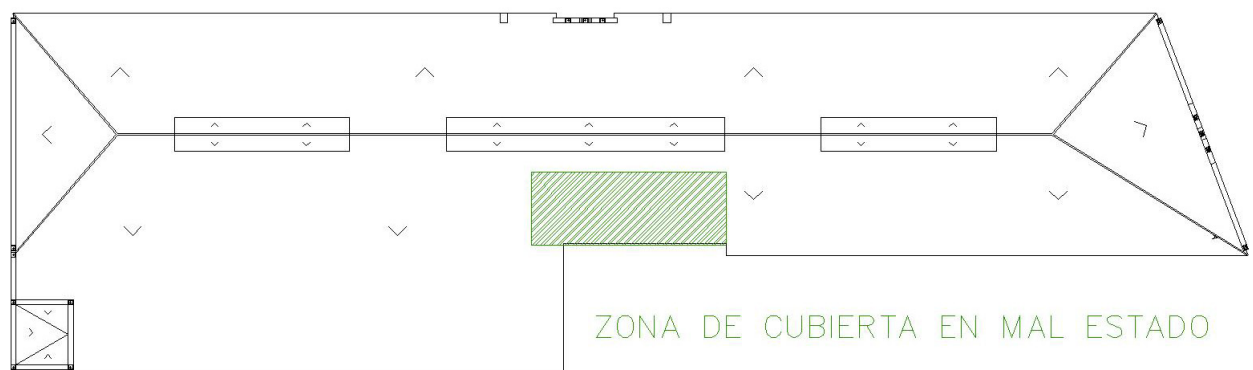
Plano de situación de la zona afectada de la cubierta..
